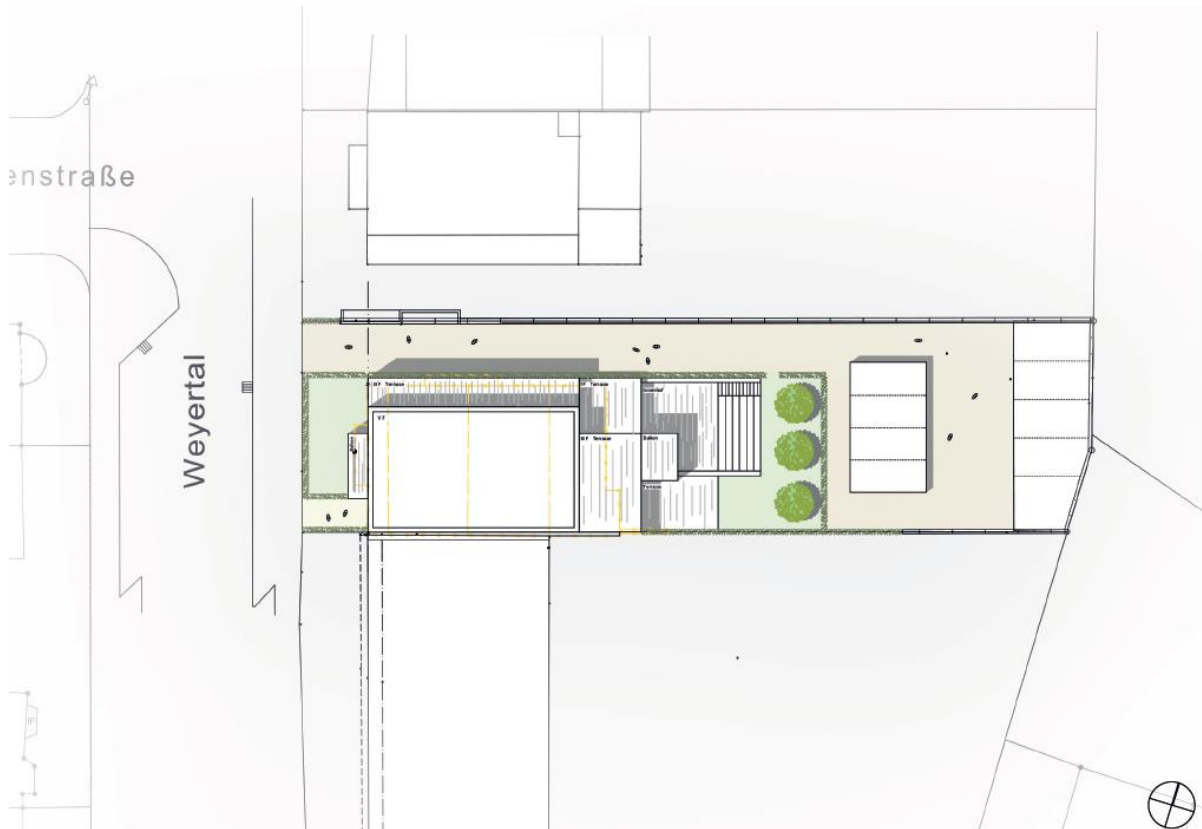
Der erste Fünfer – Lageplan (ohne Maßstab)
